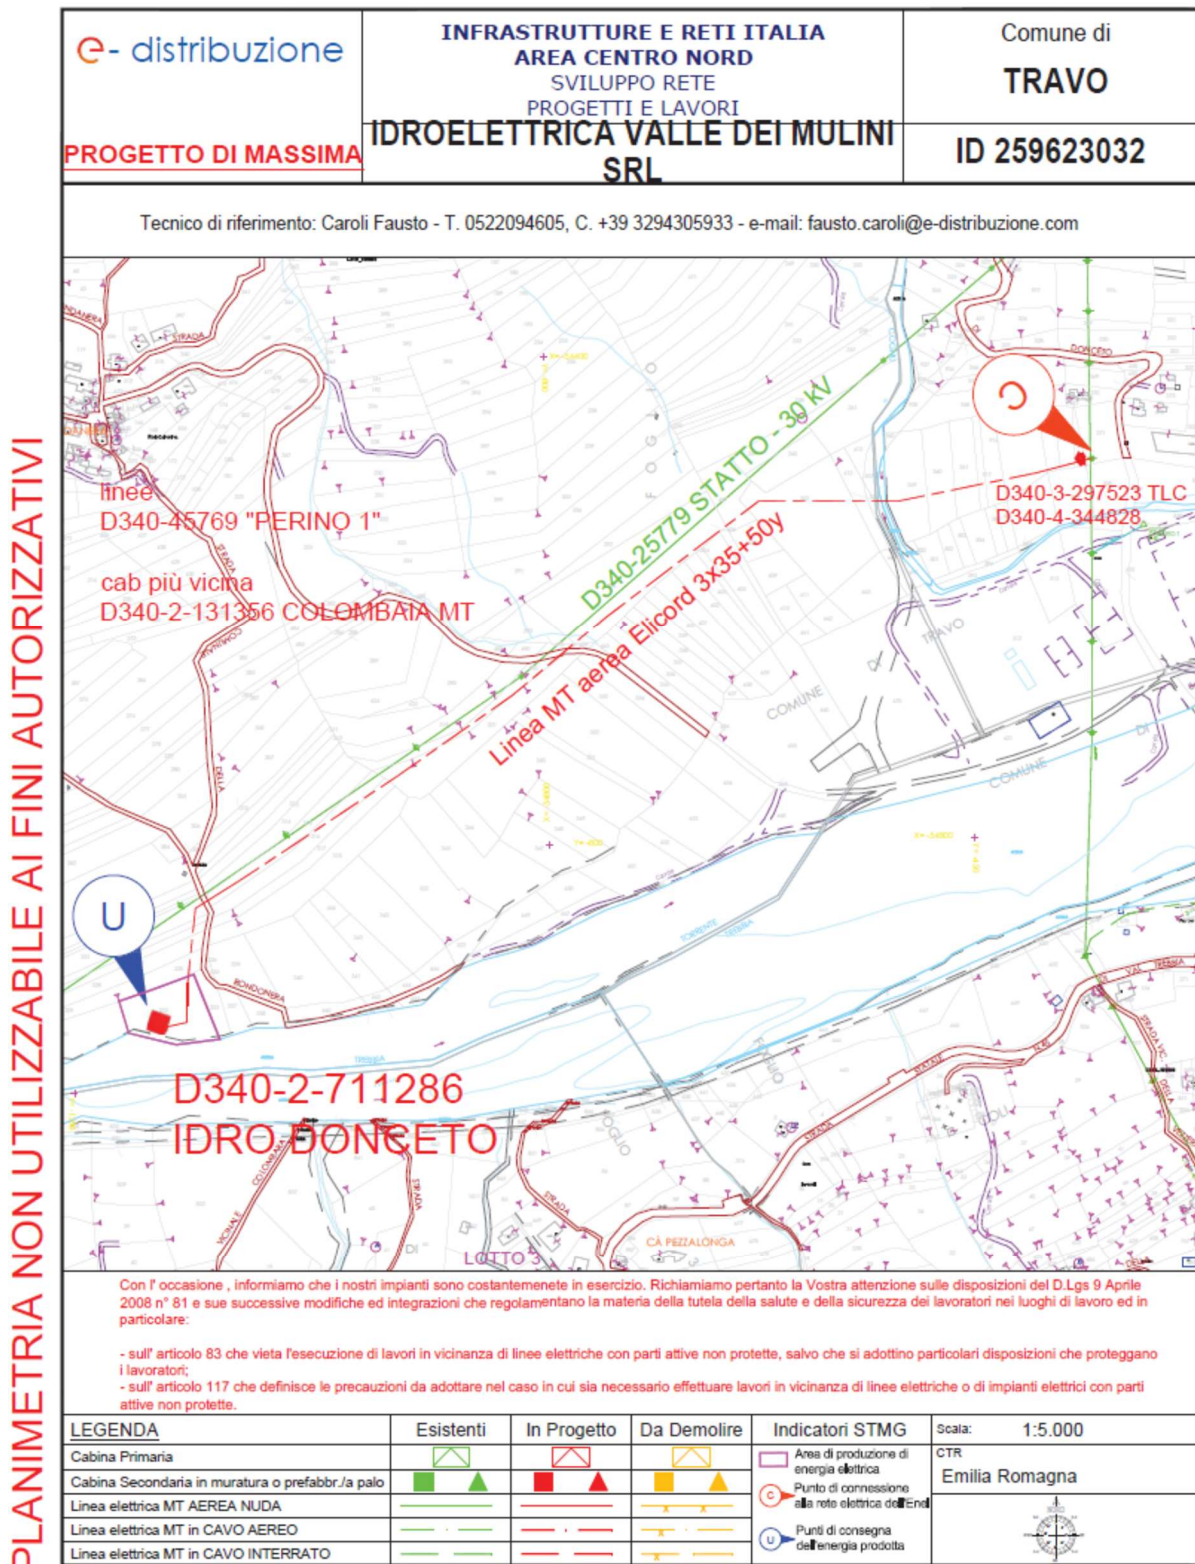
Estratto planimetrico progetto di massima preventivo di connessione.
